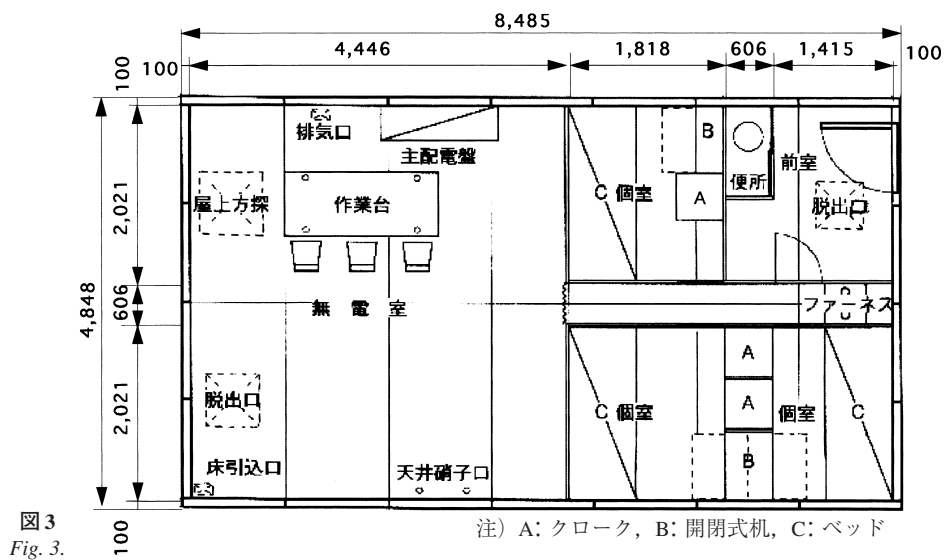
無電棟平面図 (図 3), 立面図 (図 4), 断面図 (図 5)
